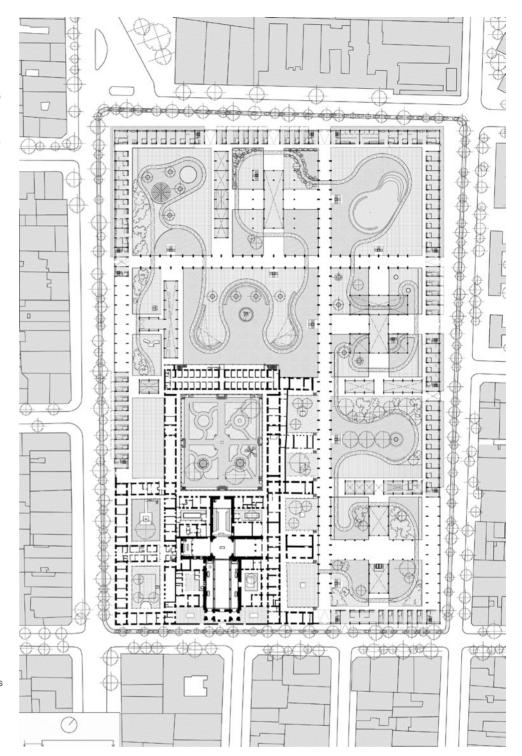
Planta general proyecto. Fuente: elaboración propia.
